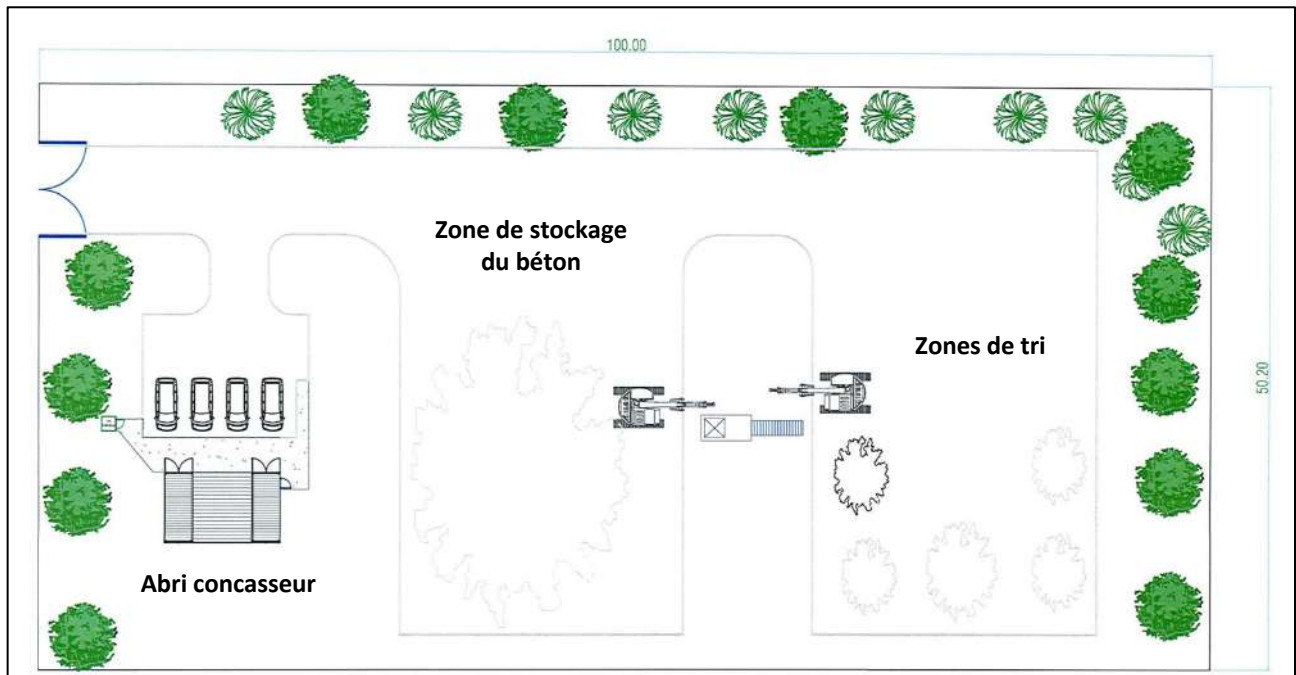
Plan des infrastructures prévues (Source : SCIAGE BETON, 2024).
